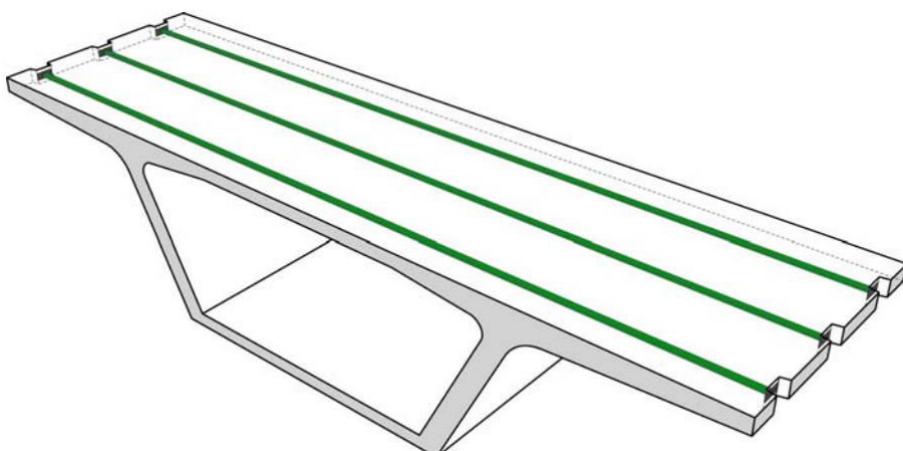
Post-tensionado transversal en la losa superior de una viga principal tipo cajón.
